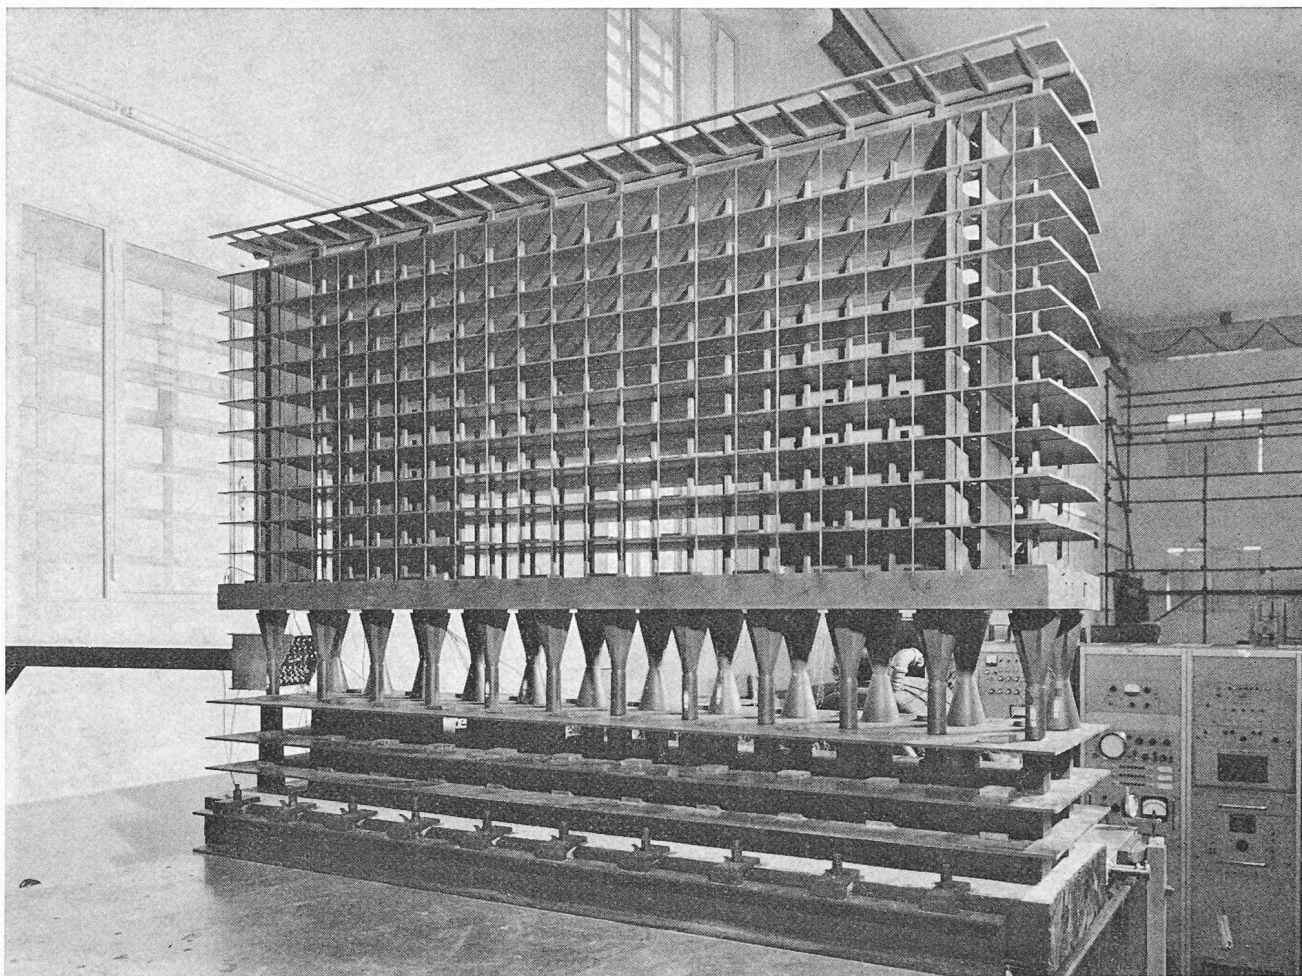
Action d'un séisme. Essais sur maquette du nouveau siège du Bureau International du Travail, Genève. Partie centrale sur portique, longueur 84 m, hauteur sur fondations 59,40 m (18 niveaux réels). Vue d'ensemble de la maquette, échelle 1 : 40. Laboratoire de l'ISMES, Bergame.
